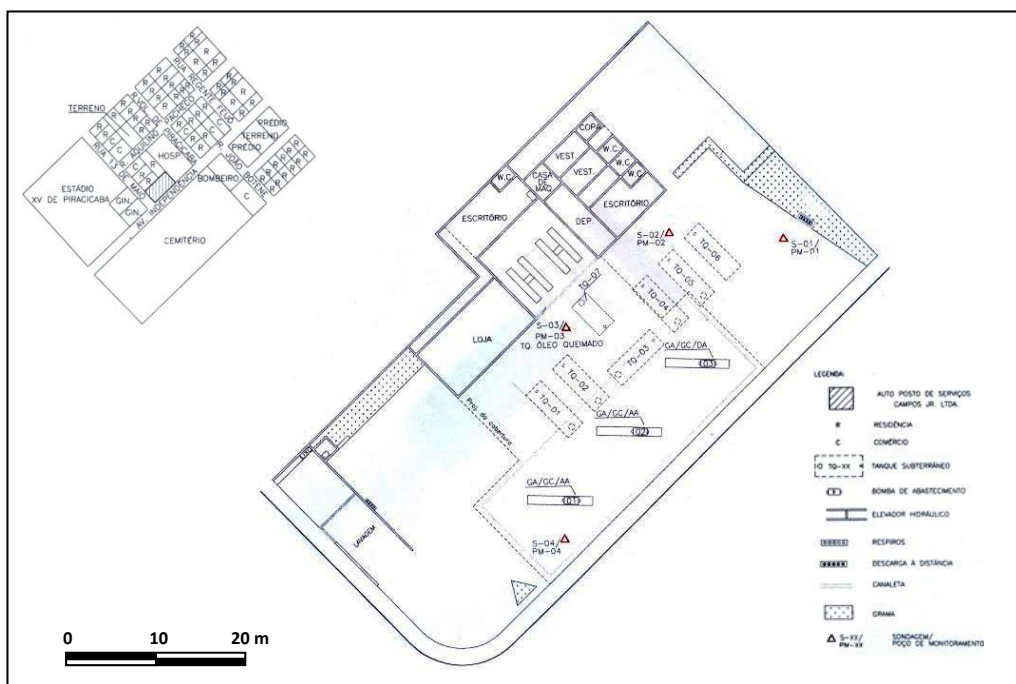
Planta baixa e croqui (sem escala) das cercanias do posto.
